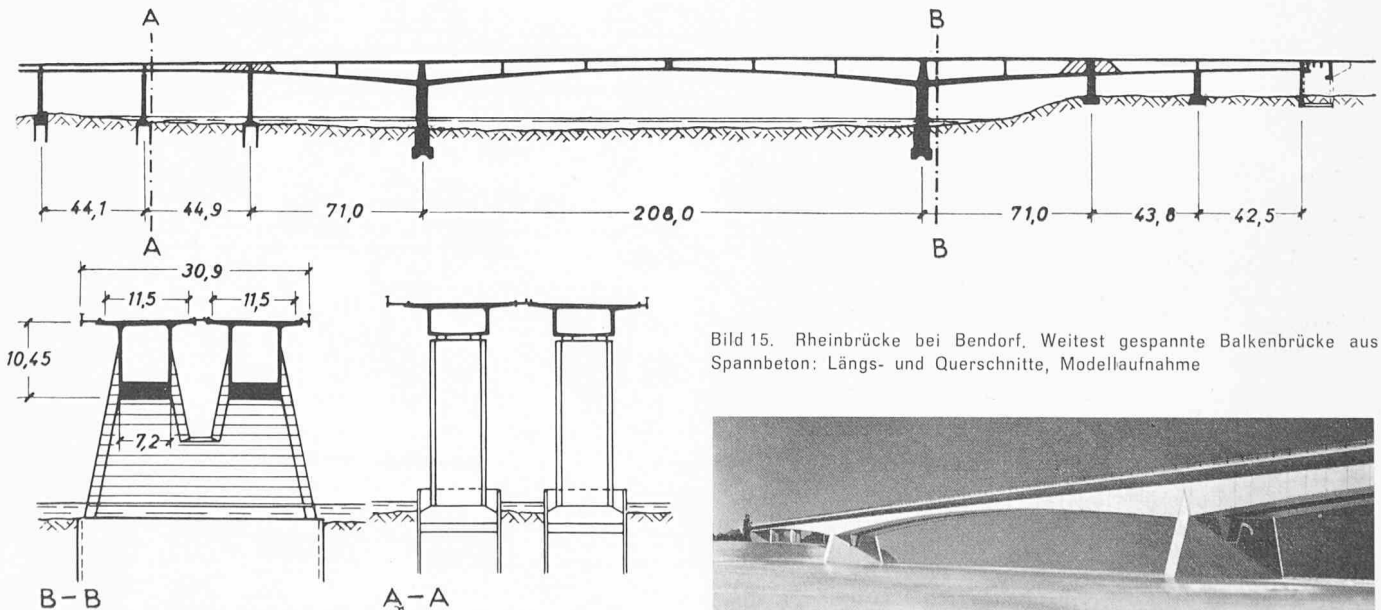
Rheinbrücke bei Bendorf. Weitest gespannte Balkenbrücke aus Spannbeton: Längs- und Querschnitte, Modellaufnahme
